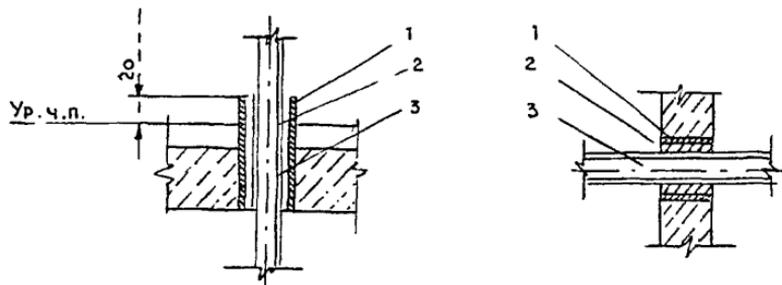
Установка гильзы для прокладки труб в стенах и перекрытиях:
